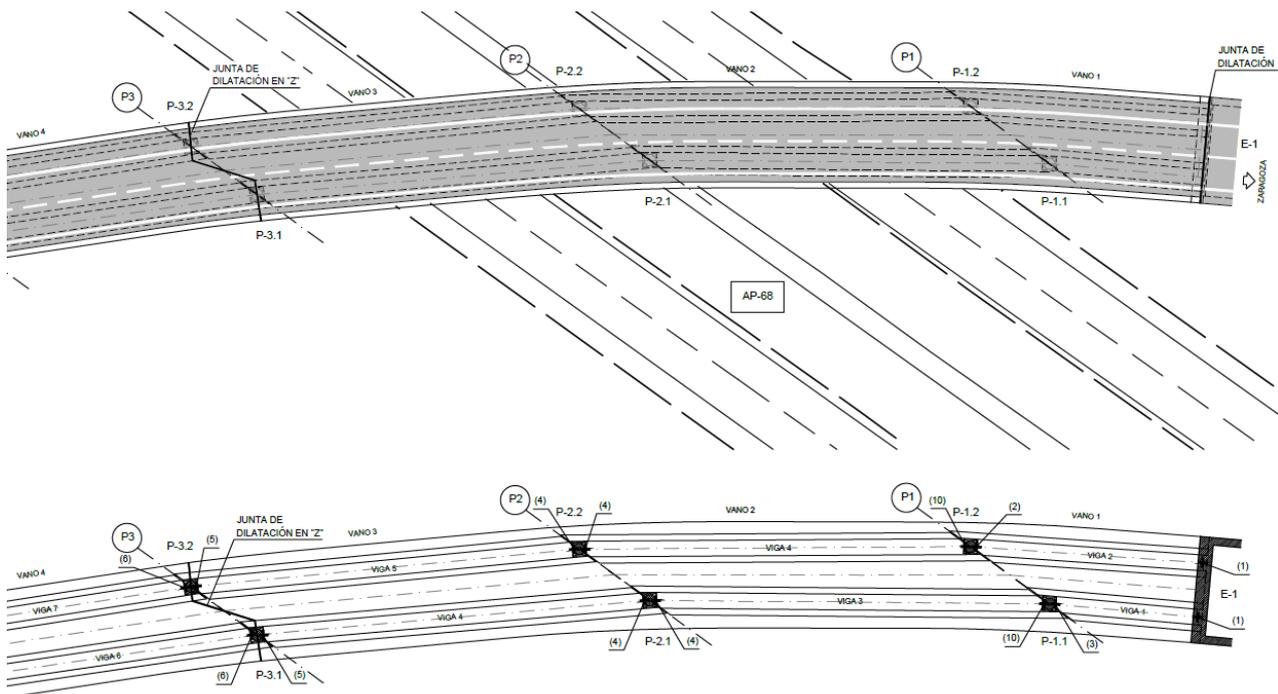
Planta del primer tramo del puente, que había sufrido desplazamiento lateral (hasta junta de dilatación “en Z” en Pila 3).
